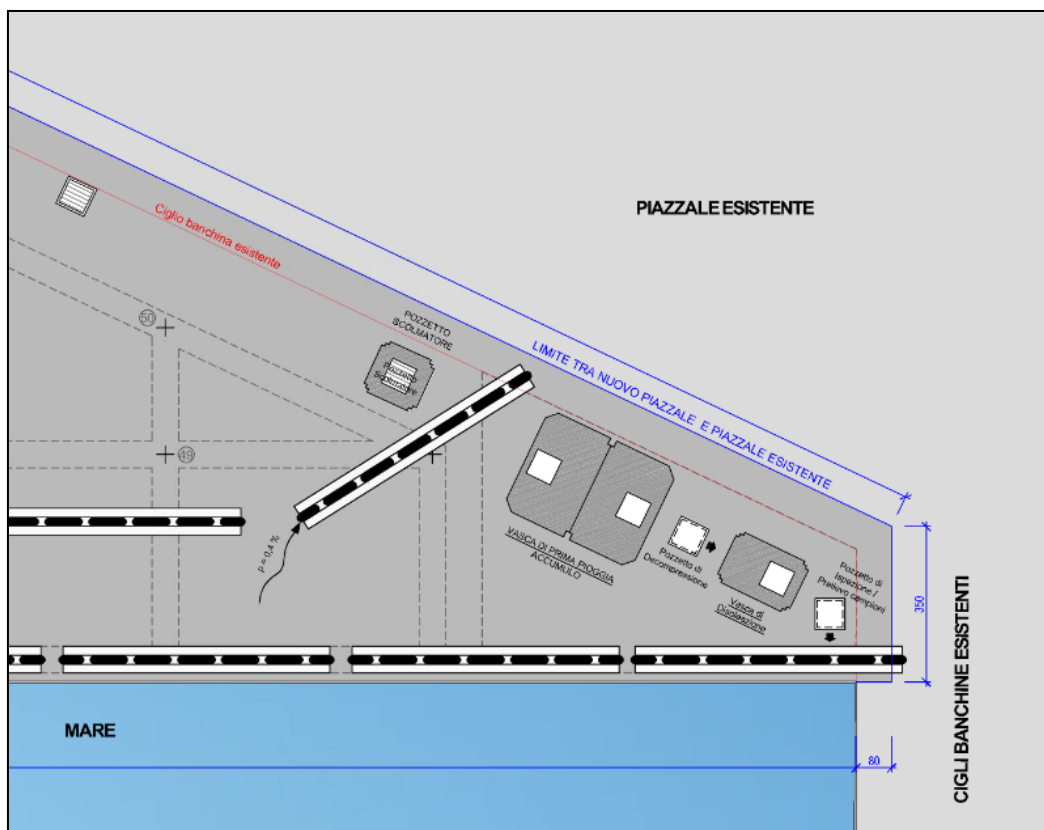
Stralcio Elaborato 3.1 - Planimetria di progetto - dettaglio impianto di trattamento acque meteoriche - progetto definitivo
